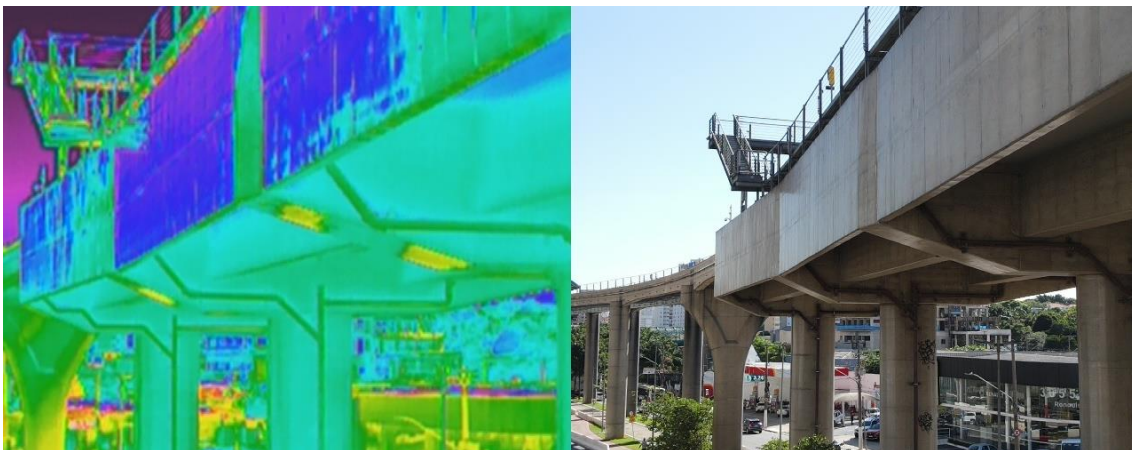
Inspeção de lajes e estruturas de *deck switch
